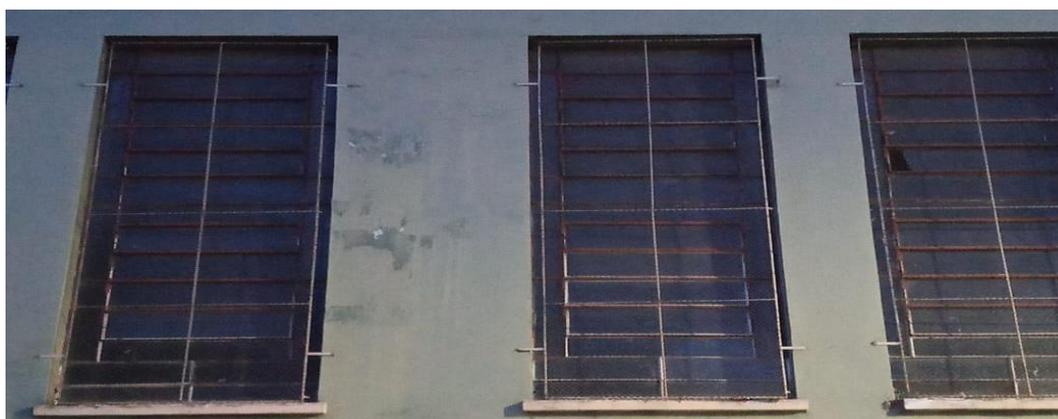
Detalhe das janelas do térreo da fachada da Rua Marechal Teodoro (pavimento superior).
